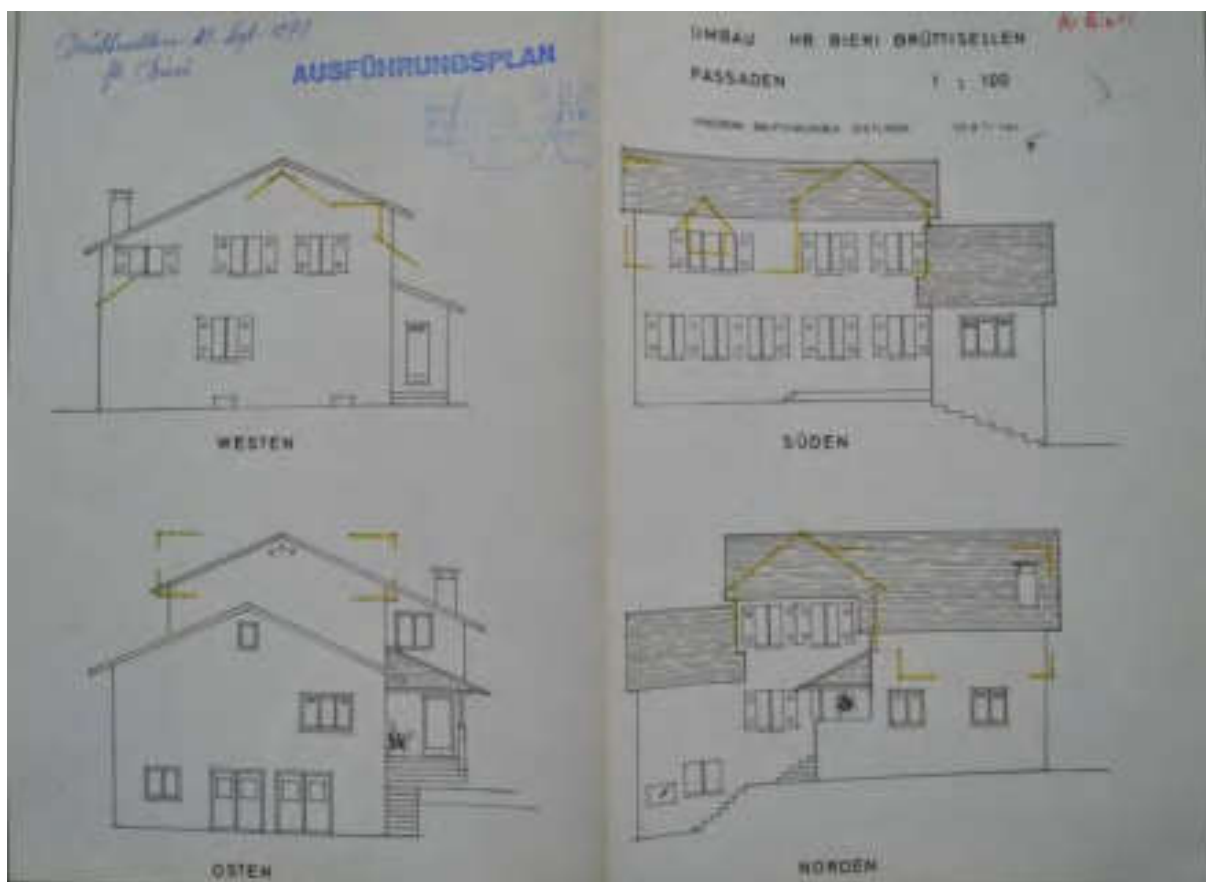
Ausführungsplan Wohnhaus Assek.-Nr. 253, Fassaden 1:100, 23.09.1971, Pinggera Bauführungen Dietlikon. Quelle: GdeA.
